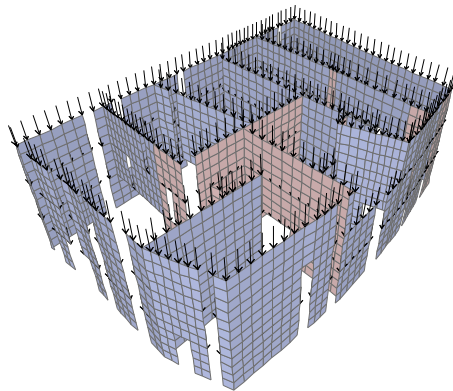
Modélisation de l'ouvrage et charges dues aux planchers
